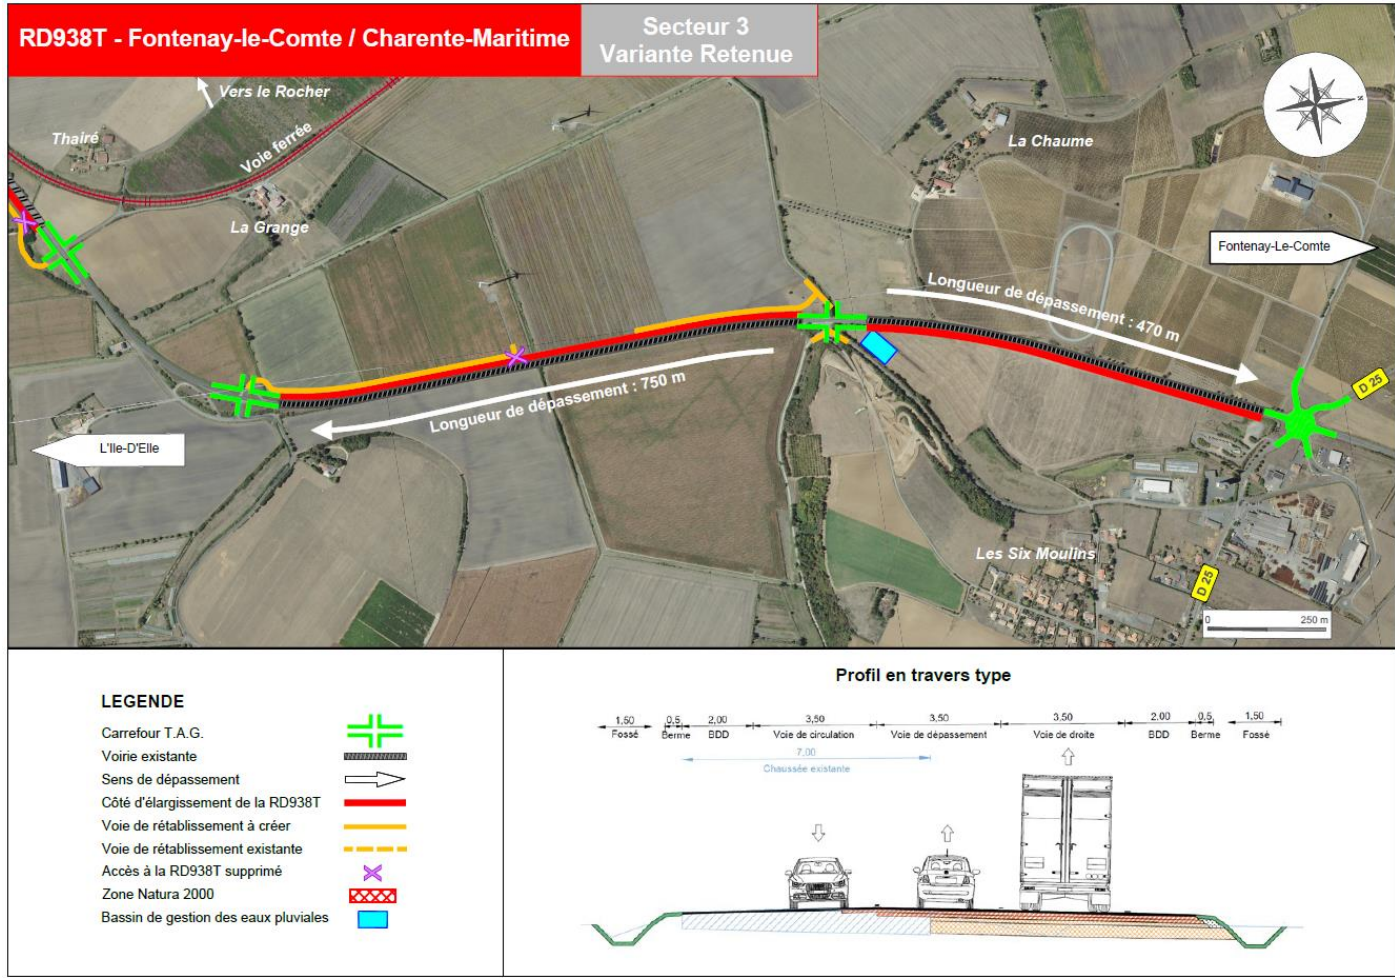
Plan simplifié du secteur 3 (Source : Iris Conseil)
